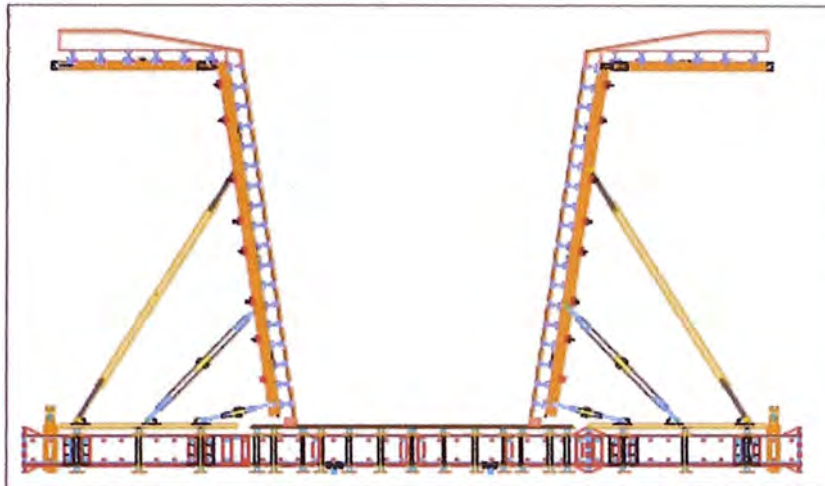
Vista sección de encofrado exterior y encofrado de fondo.
